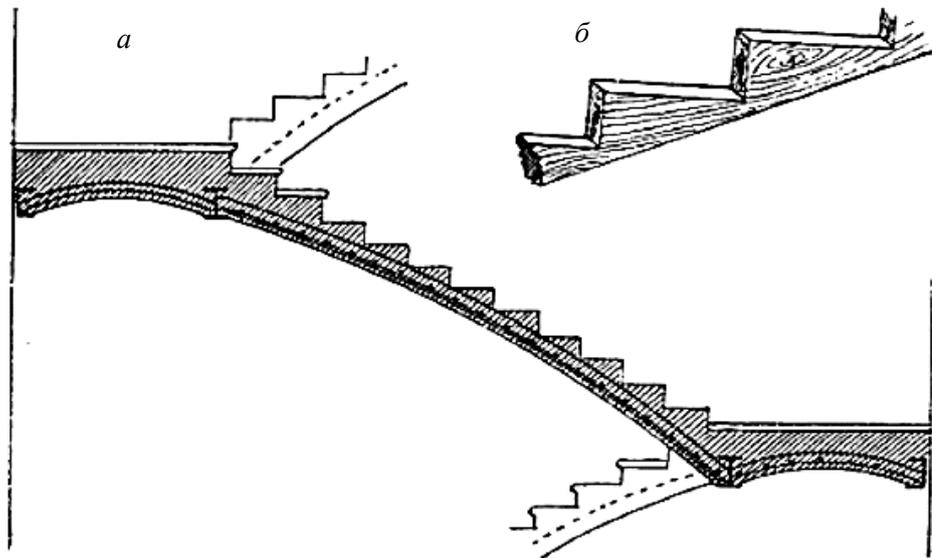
Железобетонные своды маршей (а) и деревянный косоур для него (б). М.Е. Романович, 1903 г. [1]
